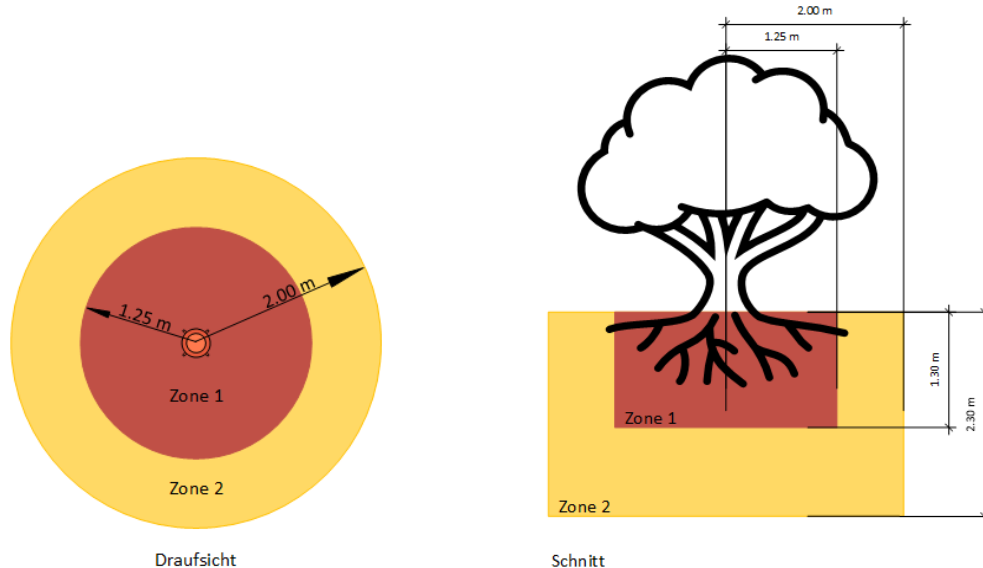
Baumzonen im Grundriss und Schnitt
